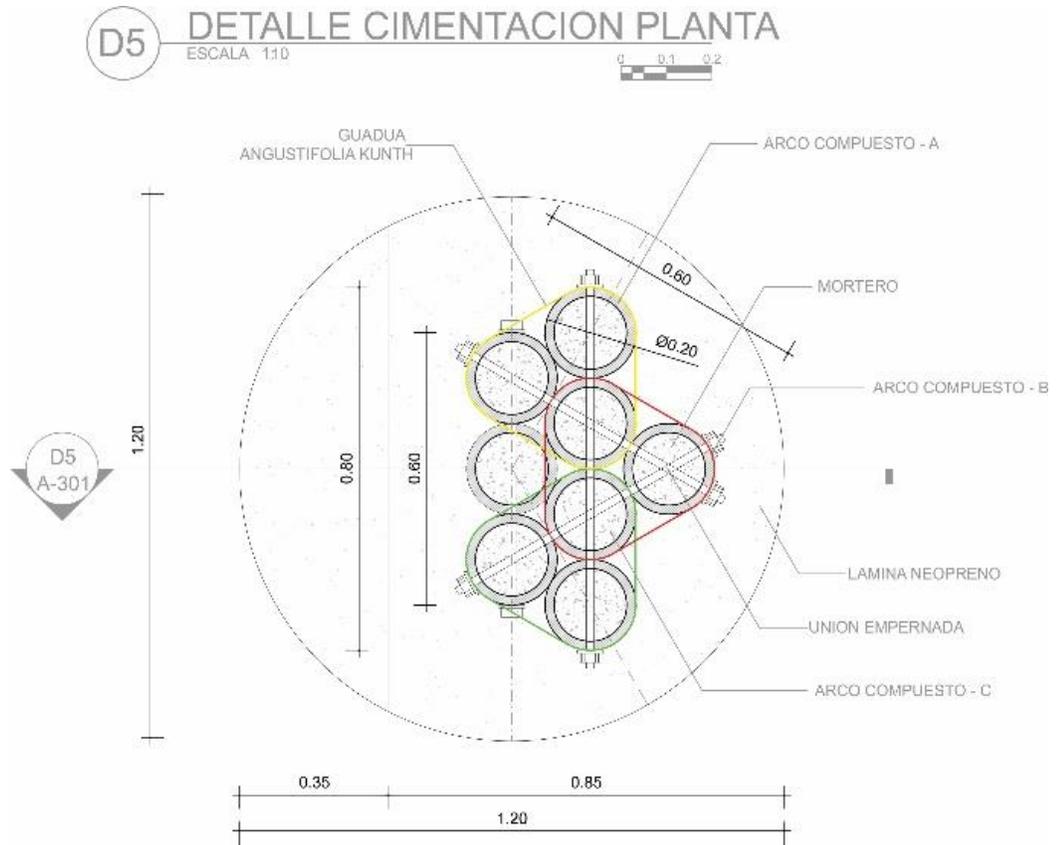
Propuesta detalle en planta cimentación parque arqueológico.
